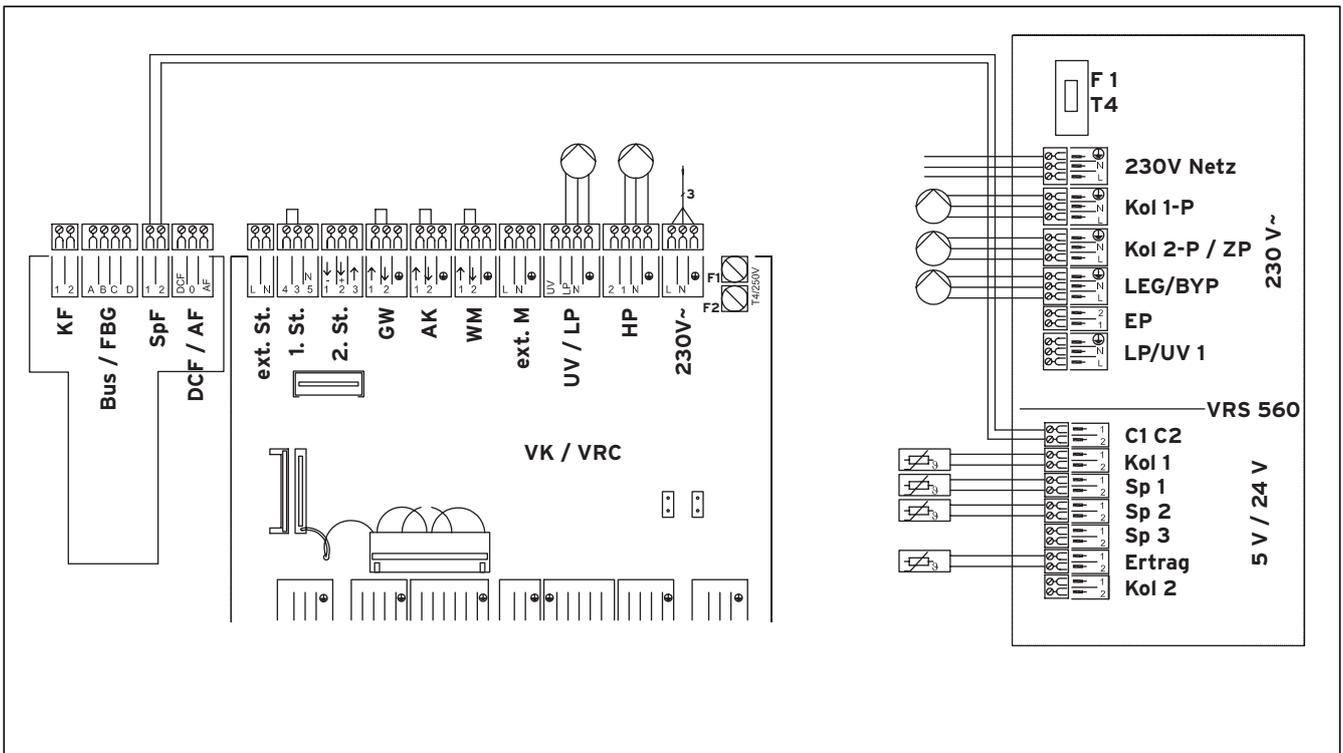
Plan de raccordement pour schéma spécifique :
